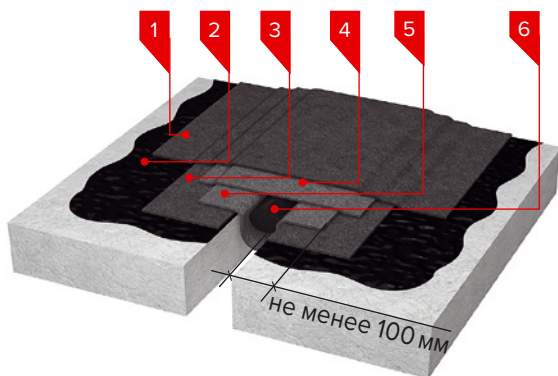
Техноэласт Фундамент ГИДРО. Обустройство горизонтального деформационного шва
